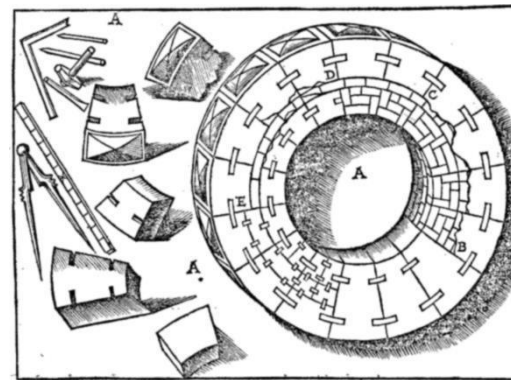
Instrumentos de trazado y labrado de la piedra. Tratado de Cesare Cesariano. Liber primus XXI.
